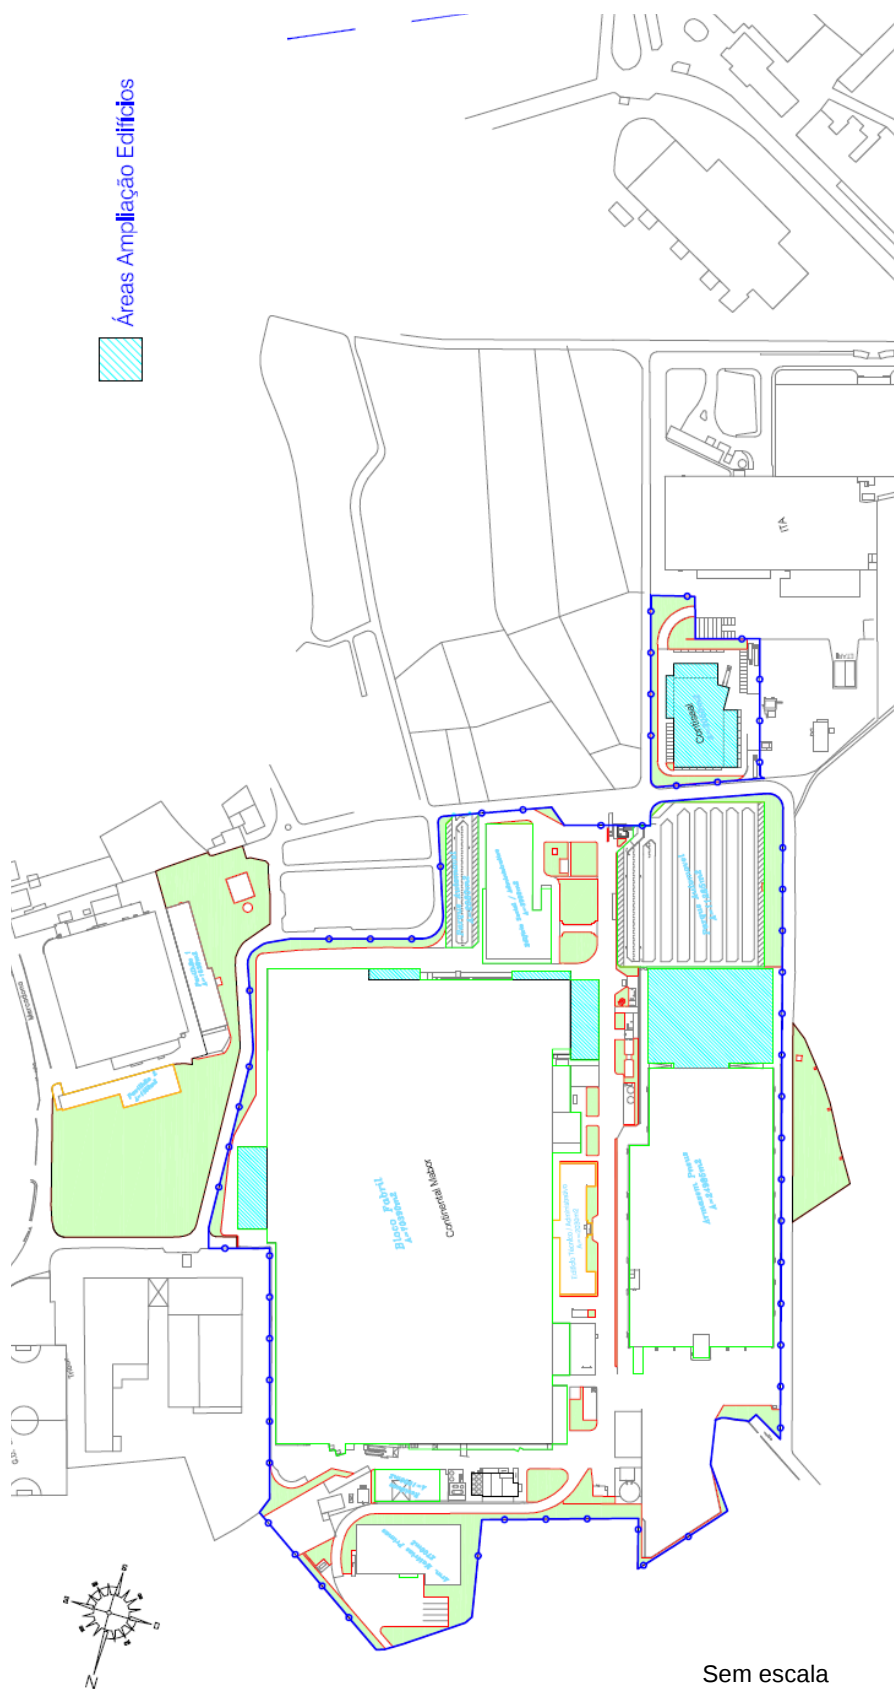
Planta de implantação da CONTINENTAL MABOR
